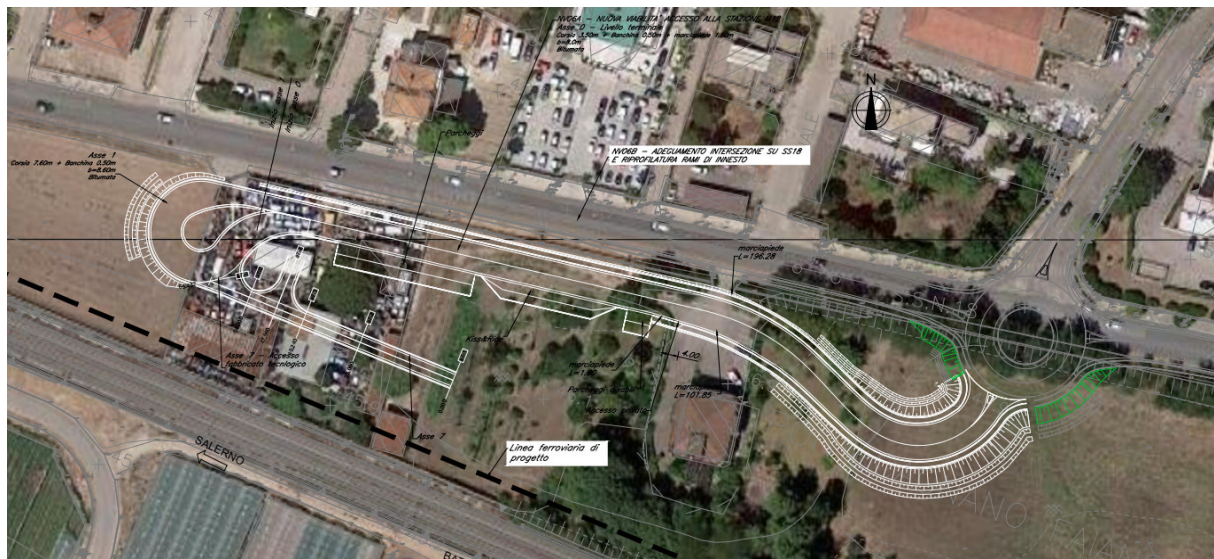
Stralcio planimetrico – NV06A_Nuova viabilità di accesso alla Stazione M12
